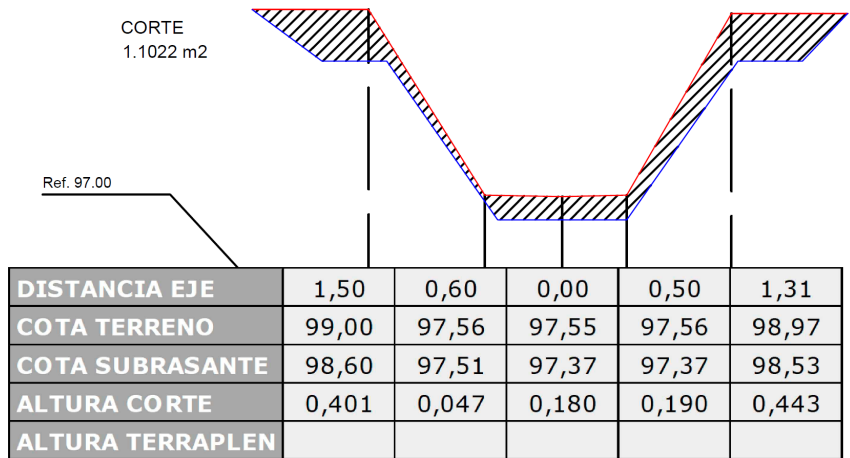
Perfil Transversal N°11 (Fuente Propia)
